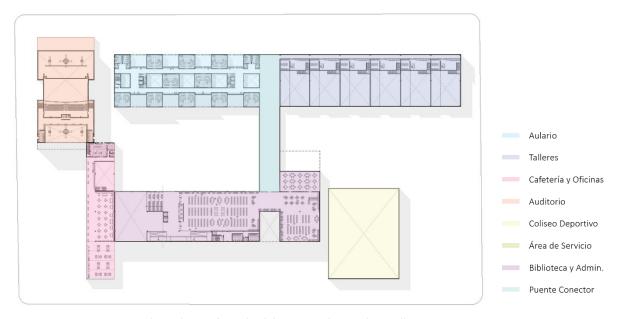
Plano de Zonificación del Instituto (segundo nivel).
